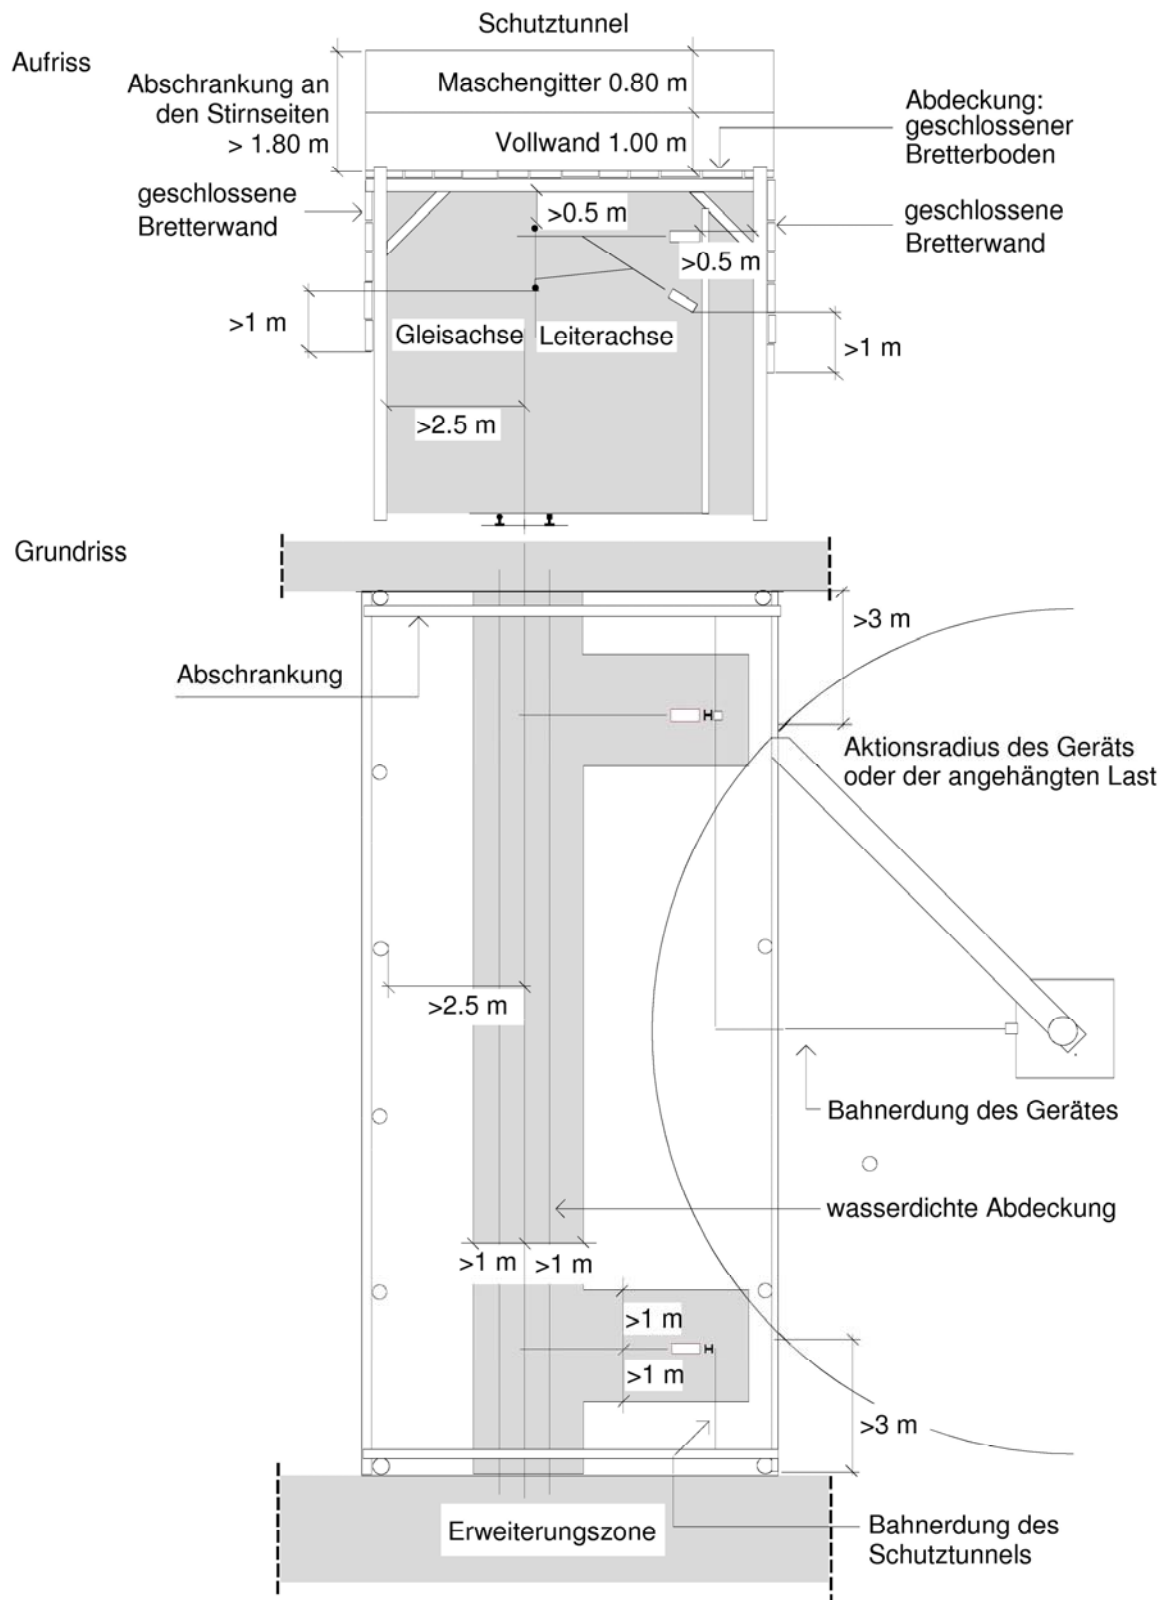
Abmessungen und Ausführung der Schutztunnel
